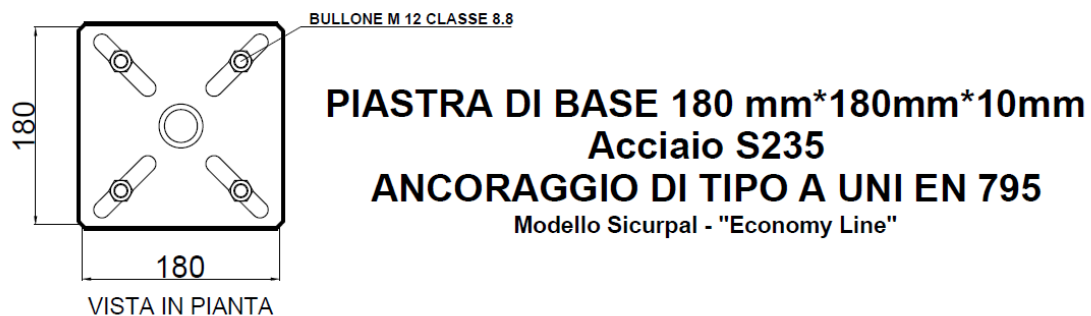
Piastra ancoraggio di tipo A³⁴
